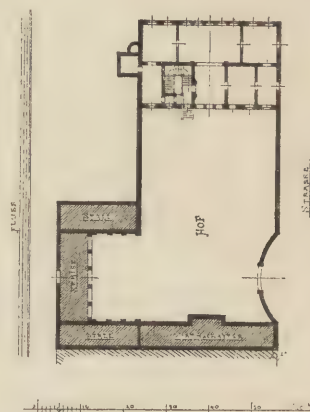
Villa Contarini zu Padua. Grundriss
